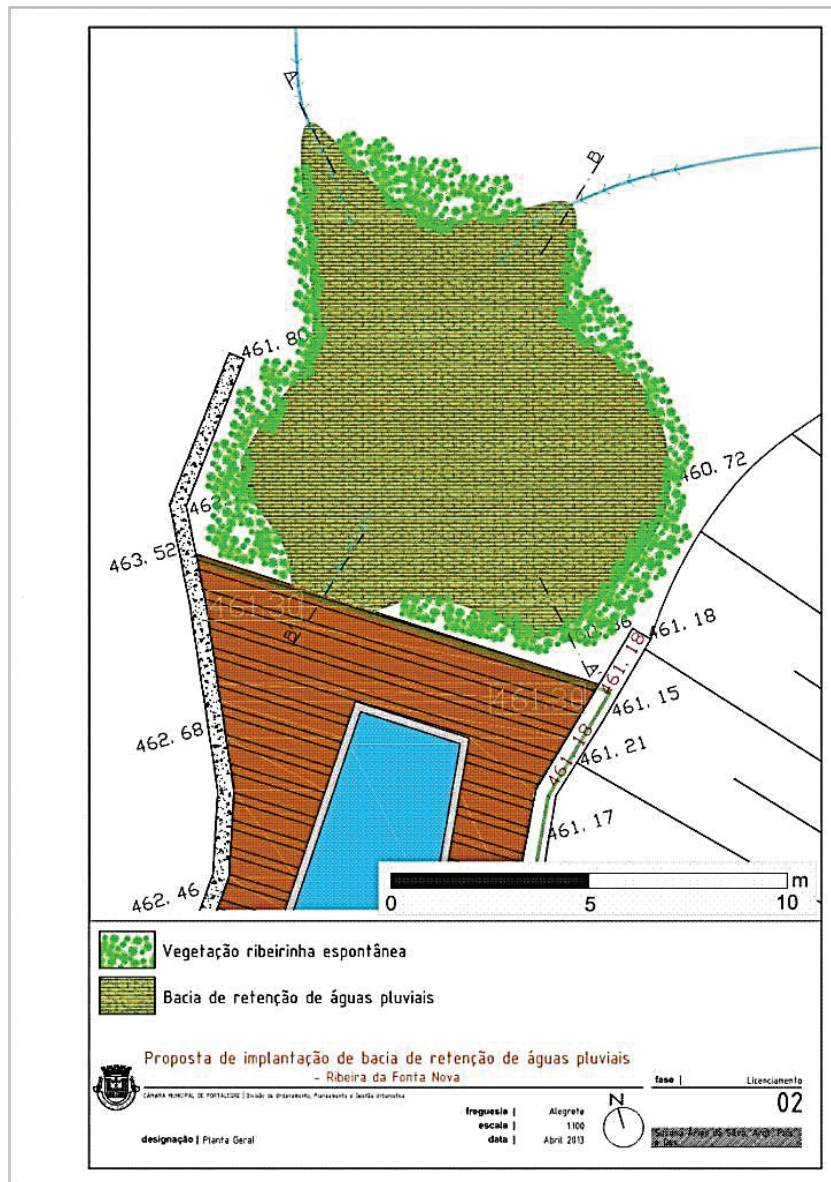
Planta Geral - 02 - Proposta de implantação de Bacia de Retenção de águas pluviais - Ribeira da Fonte Nova em Alegrete
